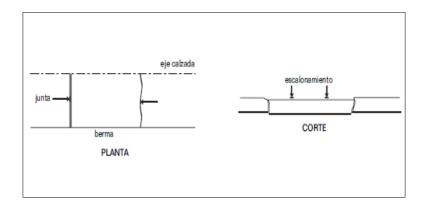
Escalonamiento de Juntas y Grietas
